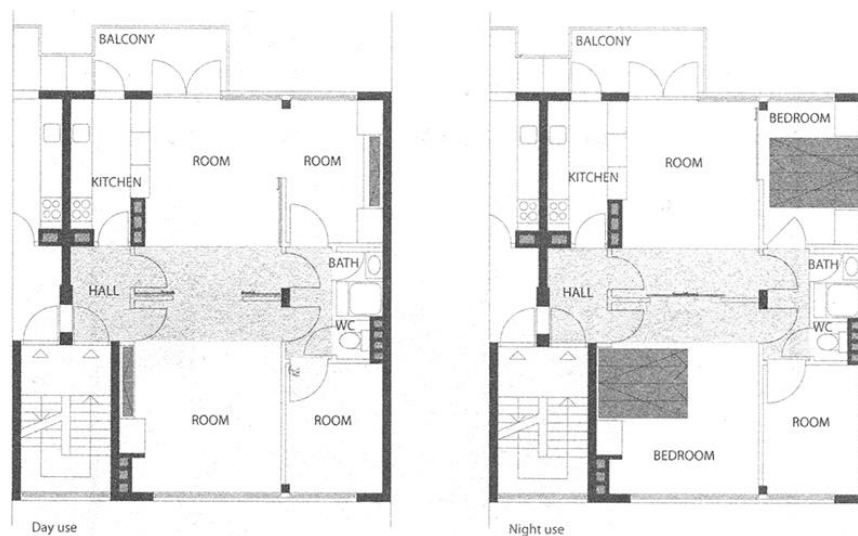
De Eendracht. Rotterdam. Plantas día y noche.
